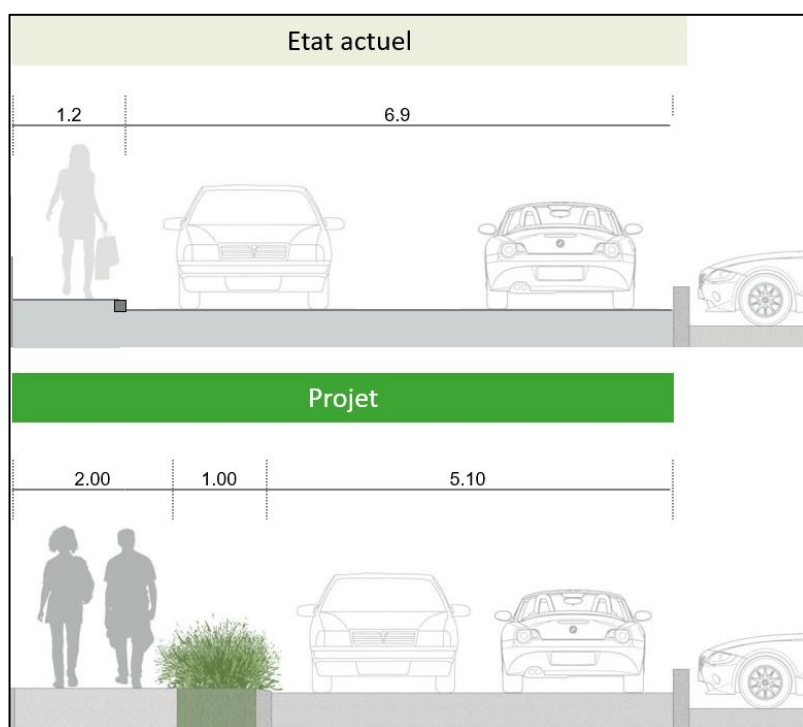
coupe-type au droit du parking communal en haut de la Rue de la Gare, gabarit fixé pour la chaussée (5.10 m), trottoir (min. 2.00 m) et jardins de poche
